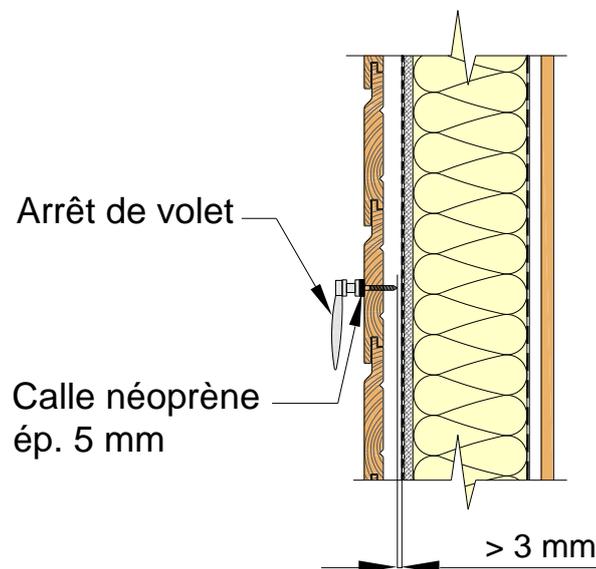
Exemple de fixation d'un arrêt de volet (coupe verticale)
